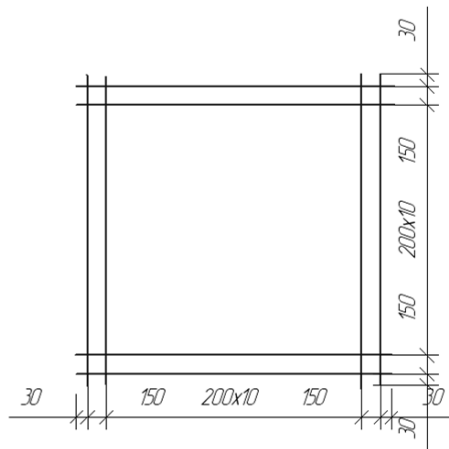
Схема сітки армування підшви фундаменту ФМ-1
